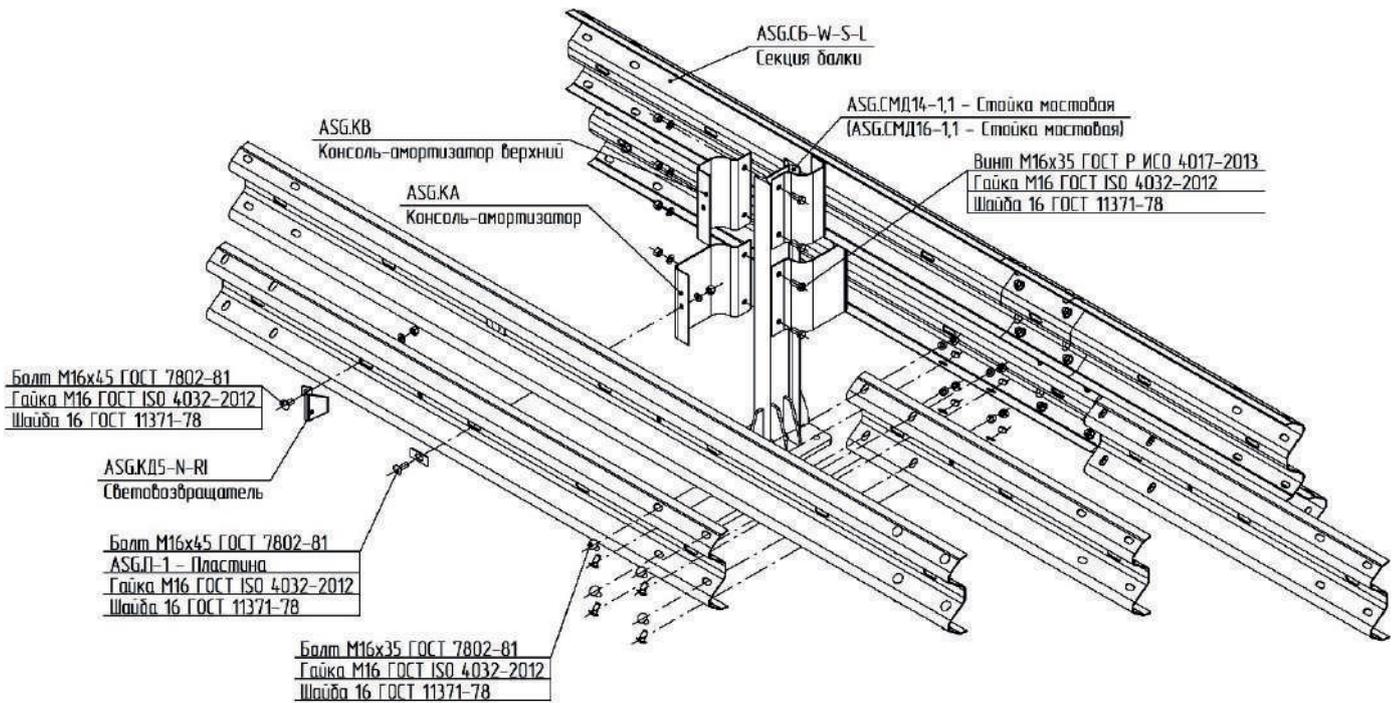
Схема сборки конструкций №24 и №25
